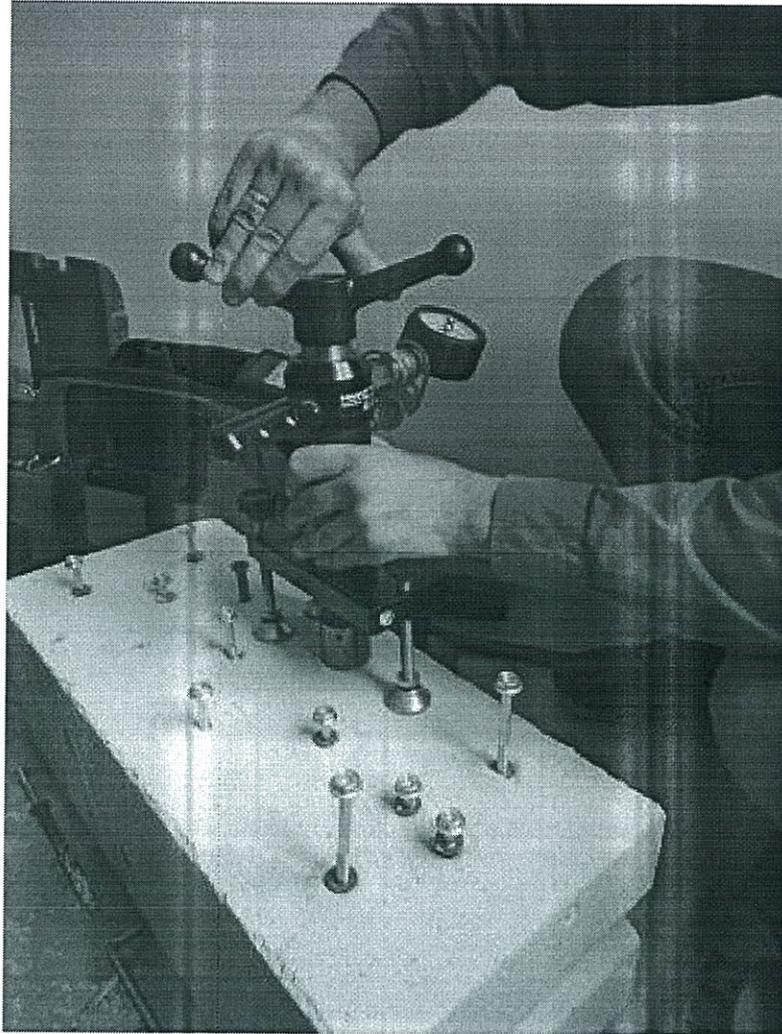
Испытание анкеров марки HRD, закреплённых в газобетонный блок
